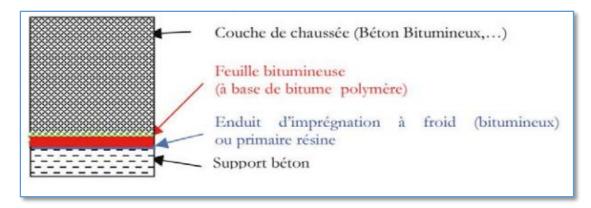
Etanchéité par feuille préfabriquée [9].
